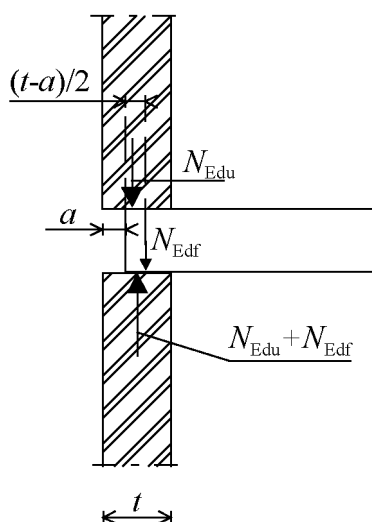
Esquema de fuerzas cuando el forjado se sustenta en parte del espesor del muro
